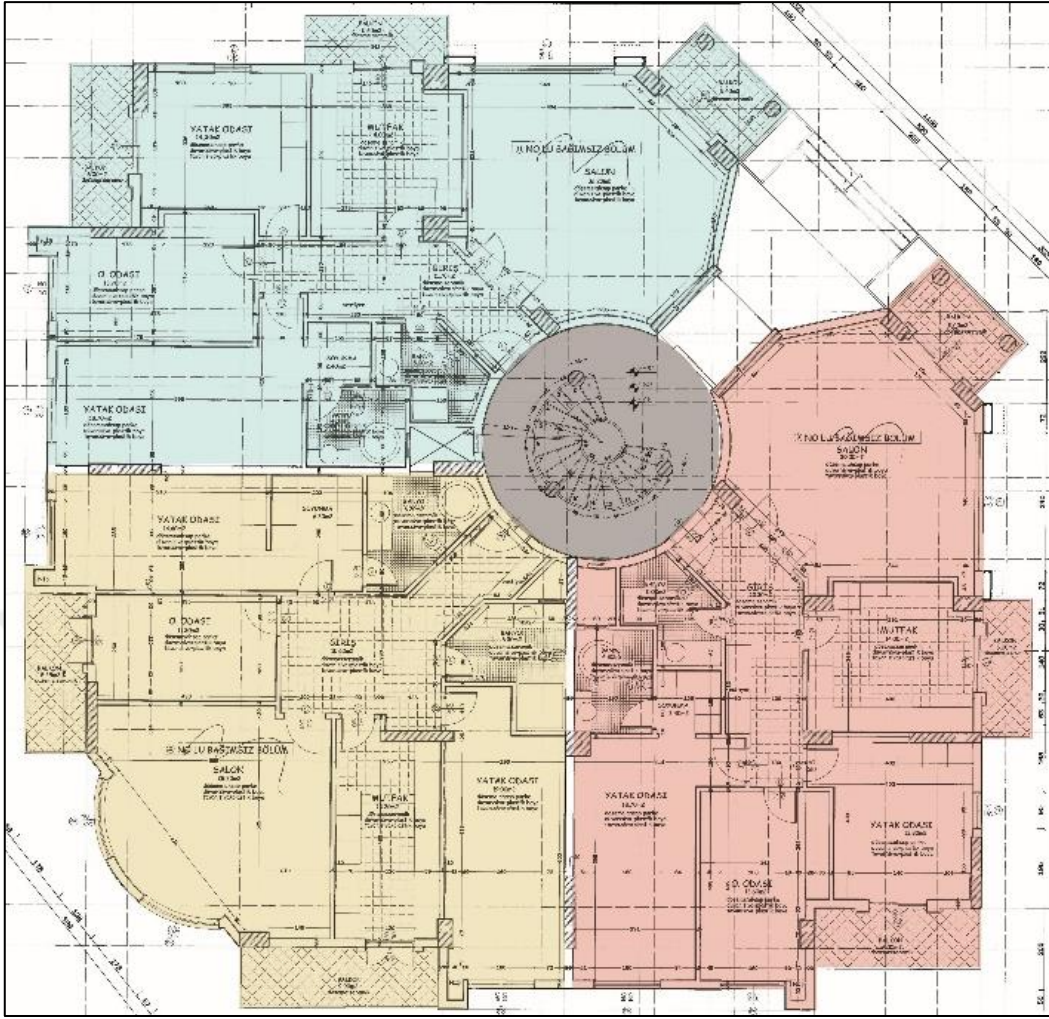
Mavi Kent Sitesi Vaziyet Planı
